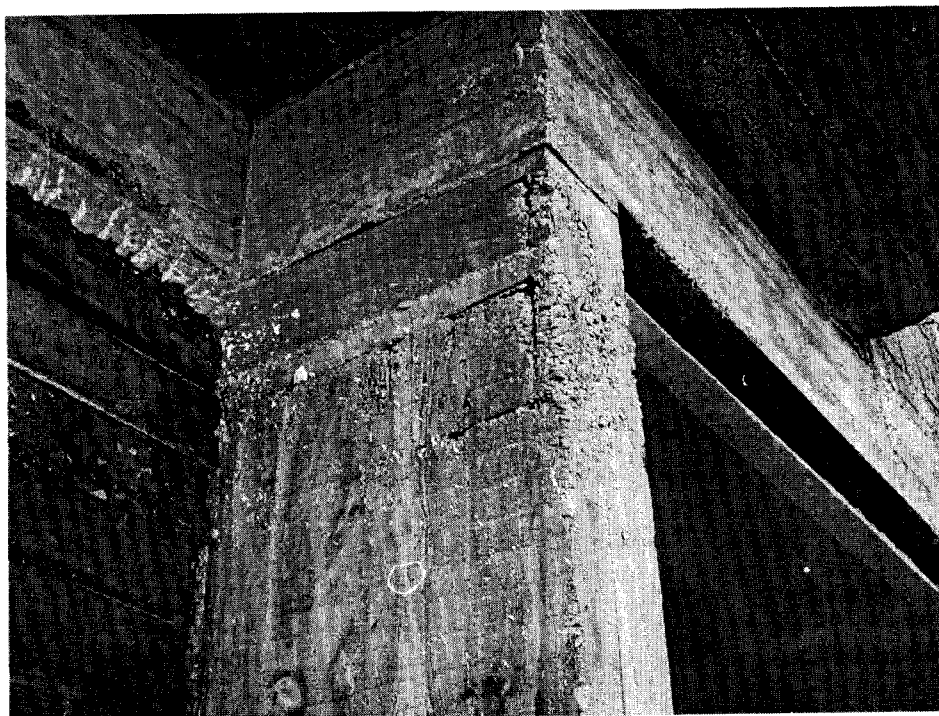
Estructura en construcción donde se detecta la falta de recubrimiento.
